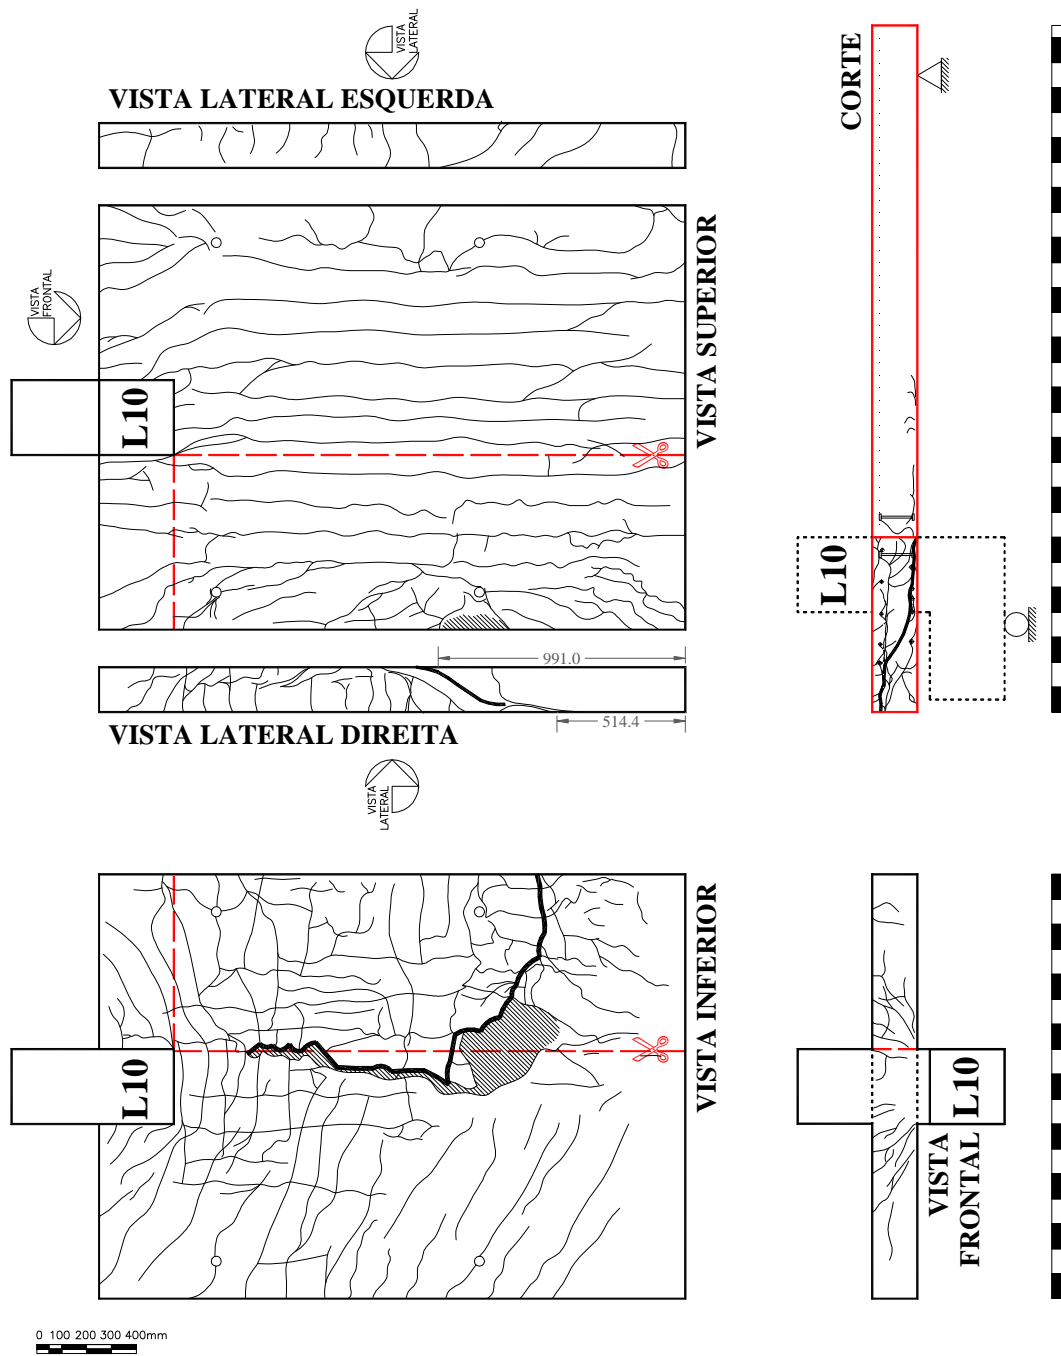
Padrão de fissuração da laje L10
